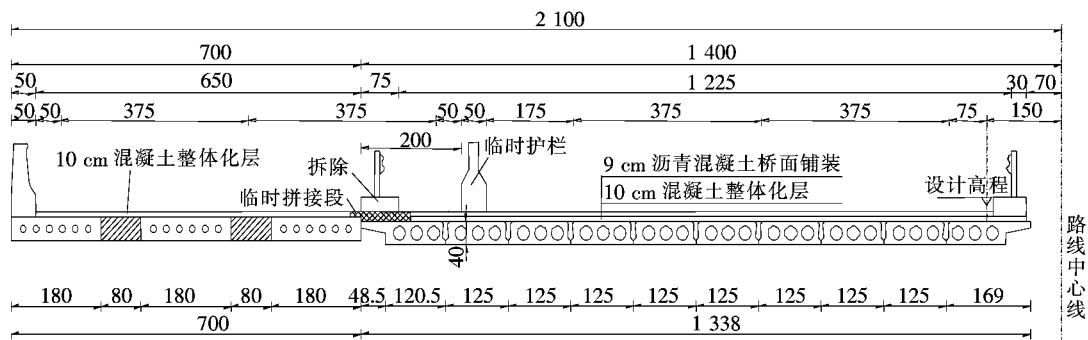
8 m 空心板临时拼接横断面示意图(单位:cm)
